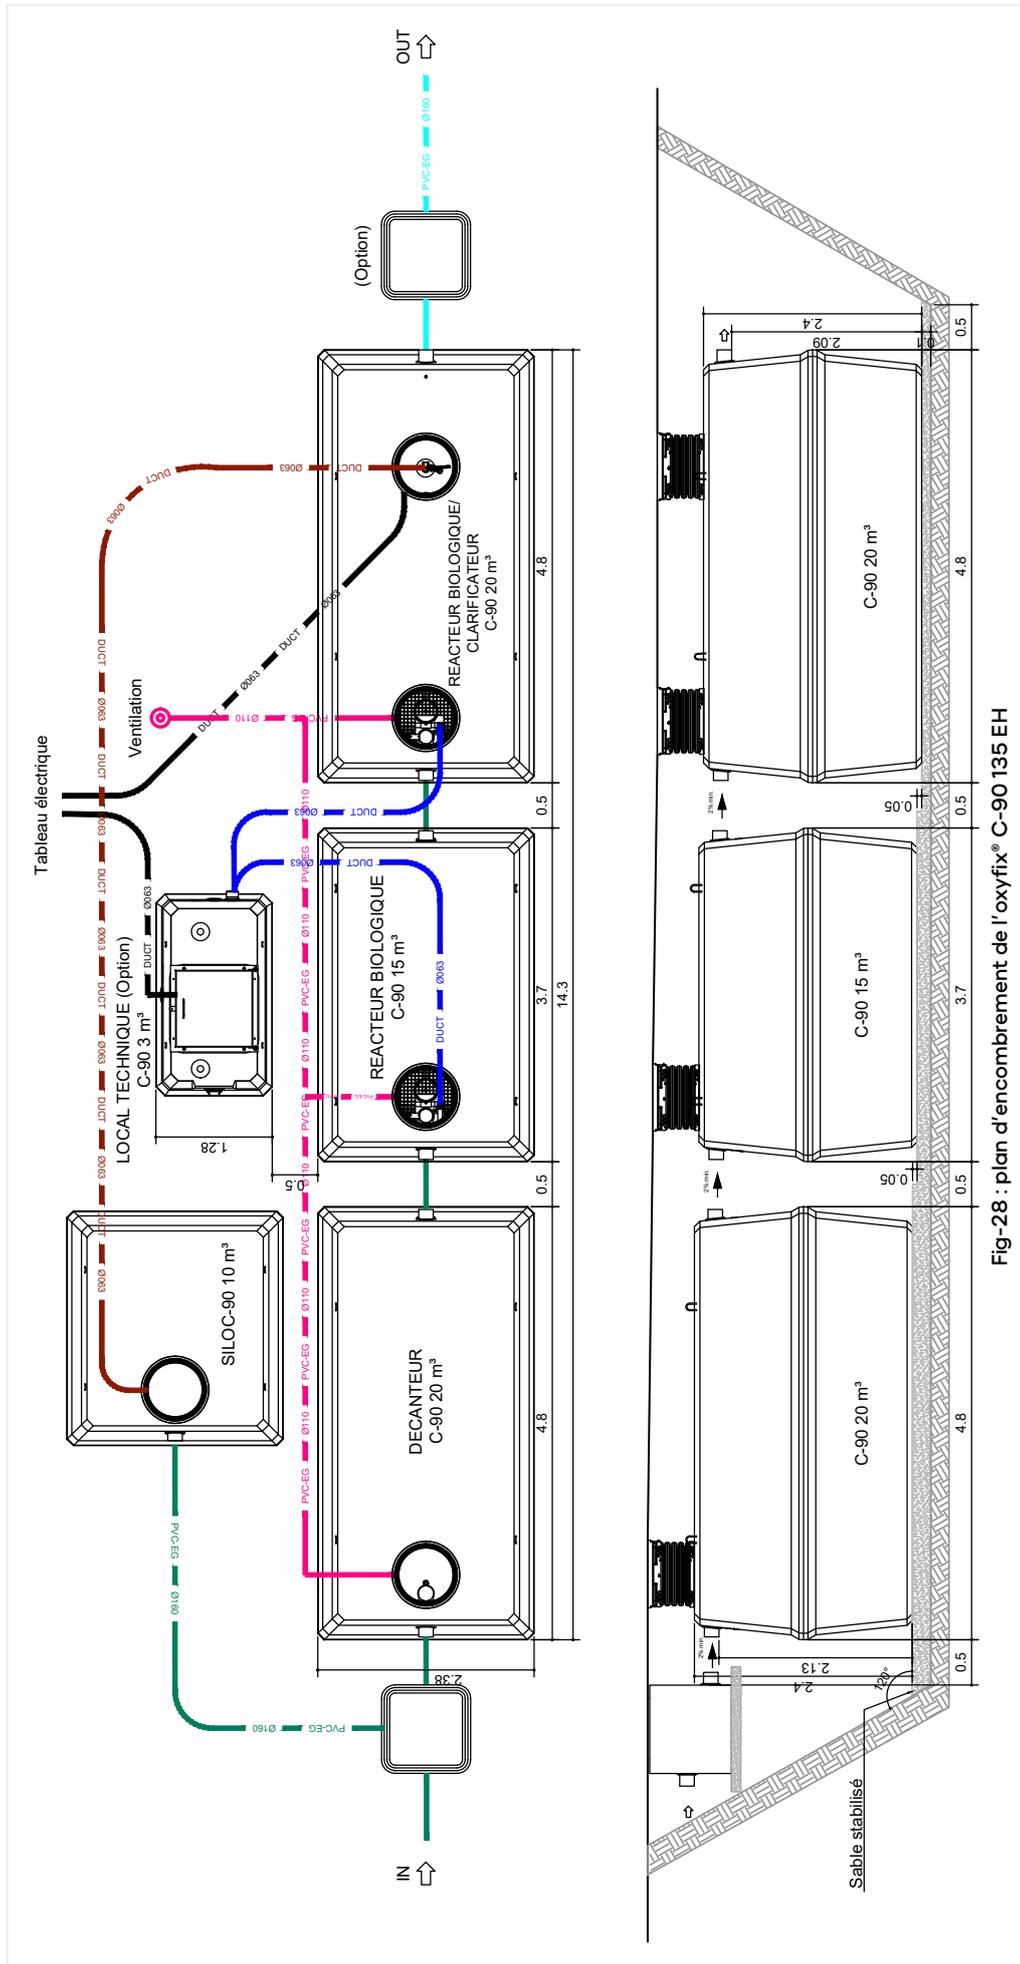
plan d'encombrement de l'oxyfix® C-90 135 EH
